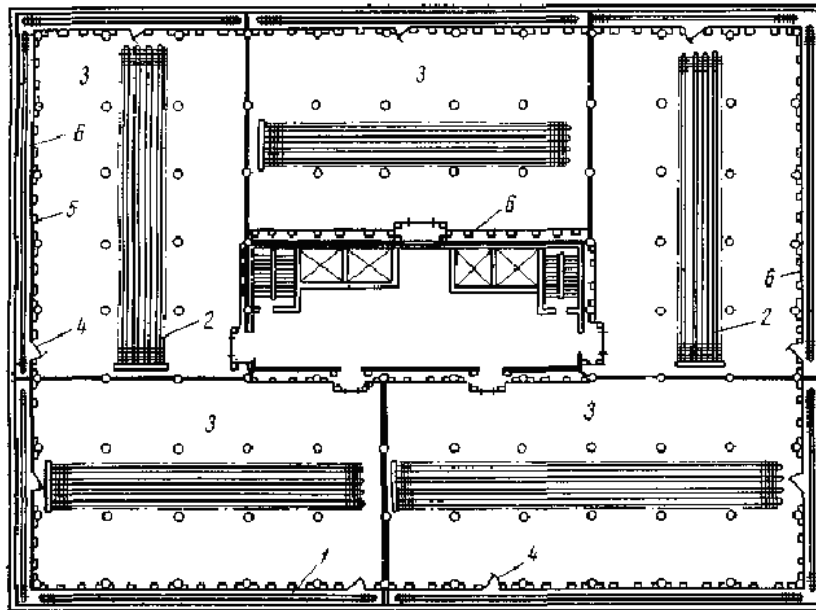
Камери зберігання із крижаними екранами: 1 – пристінні оребрені батареї; 2 - стельова батарея; 3 – камера зберігання; 4 – двері; 5 – стійки для кріплення дерев'яних рам; 6 – крижані екрани
